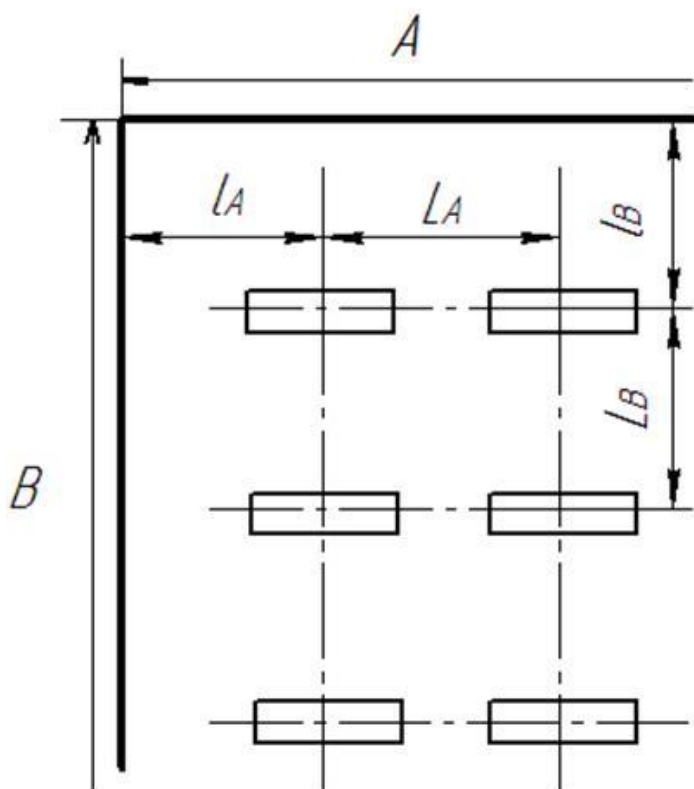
Фрагмент план помещения при освещении газоразрядными светильниками.
